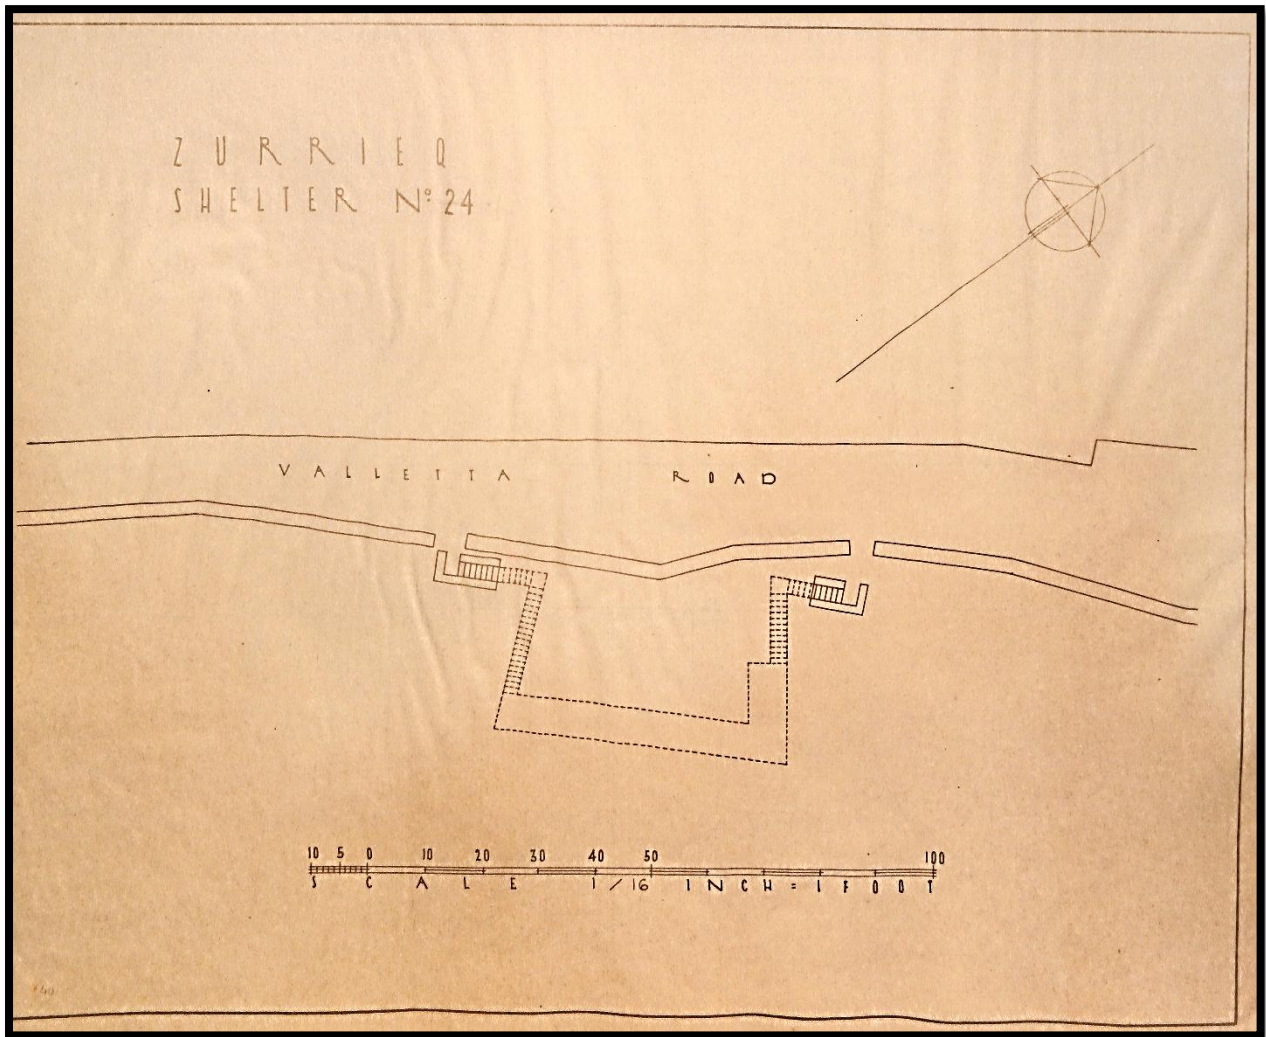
Planta do Abrigo nº24 "Valletta Road"
